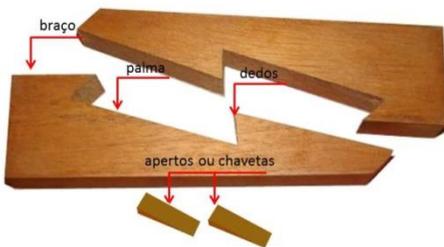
Detalhes da samblagem mão-de-amigo.
